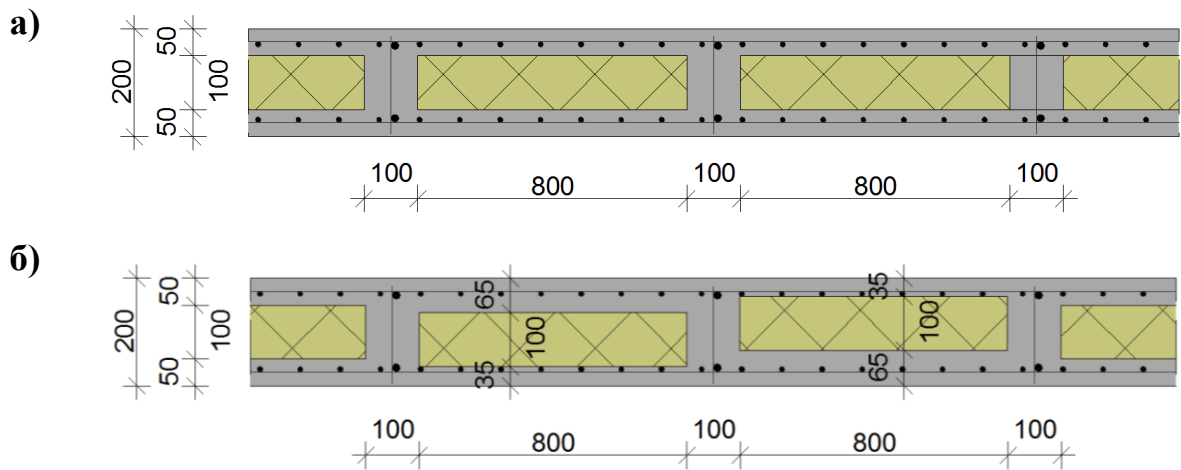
Плита перекриття з нормальним перерізом (а) та з відхиленнями (б)
